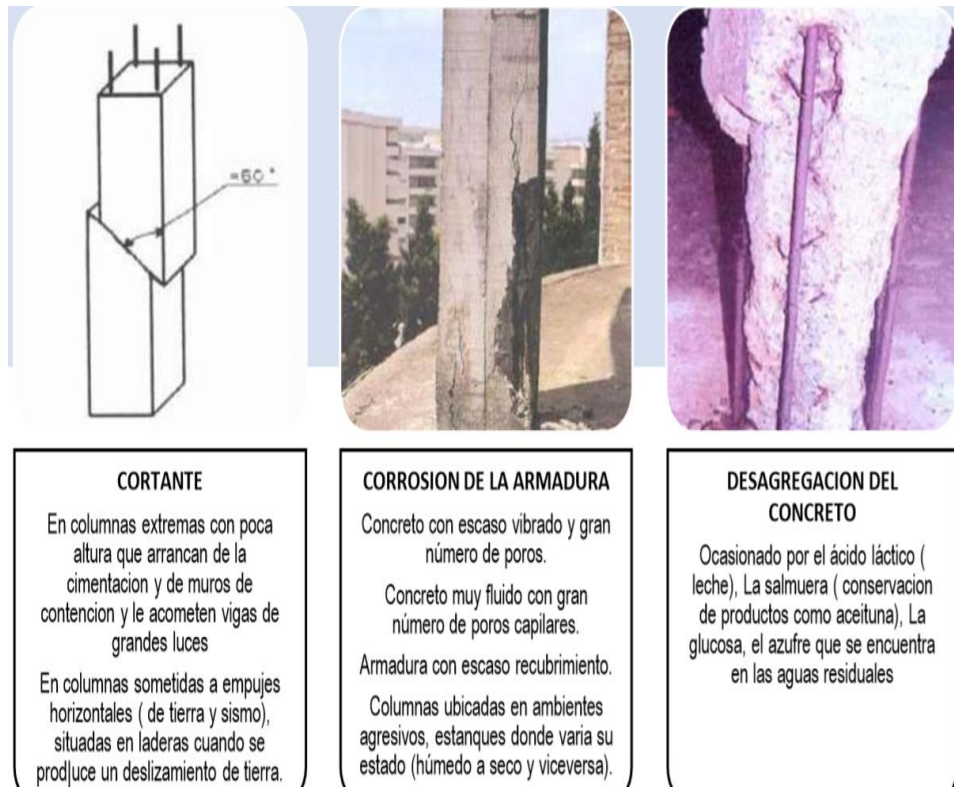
Fallas más comunes de columnas, Fuente: Modificado de (Torrealva, D., 2007)
